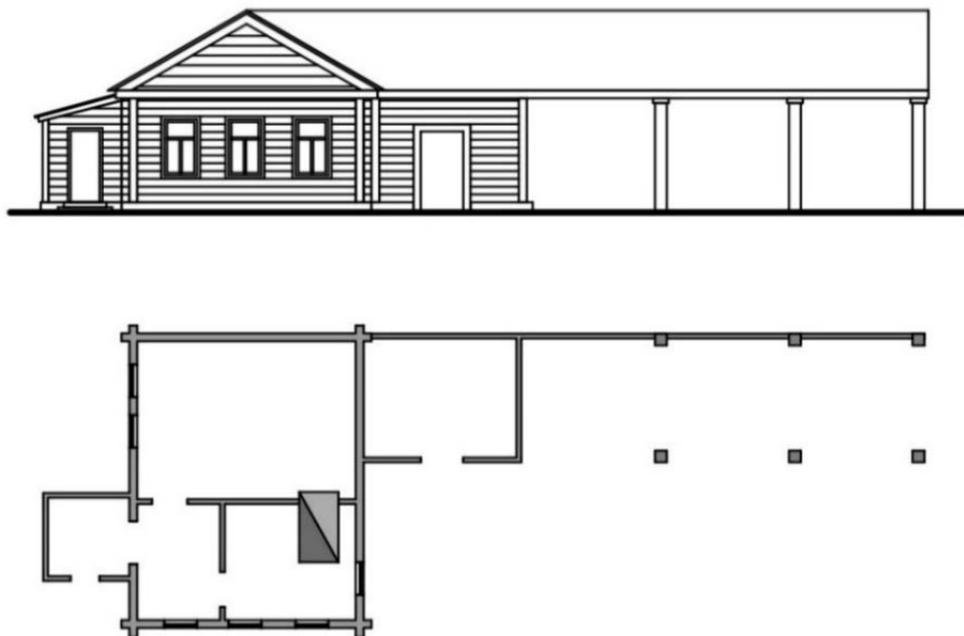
Схема фасада и плана надворной постройки на усадьбе Миншутиных (по материалам ГБУТО ГАТО Фонд И1. О. 1. Д. 402)
